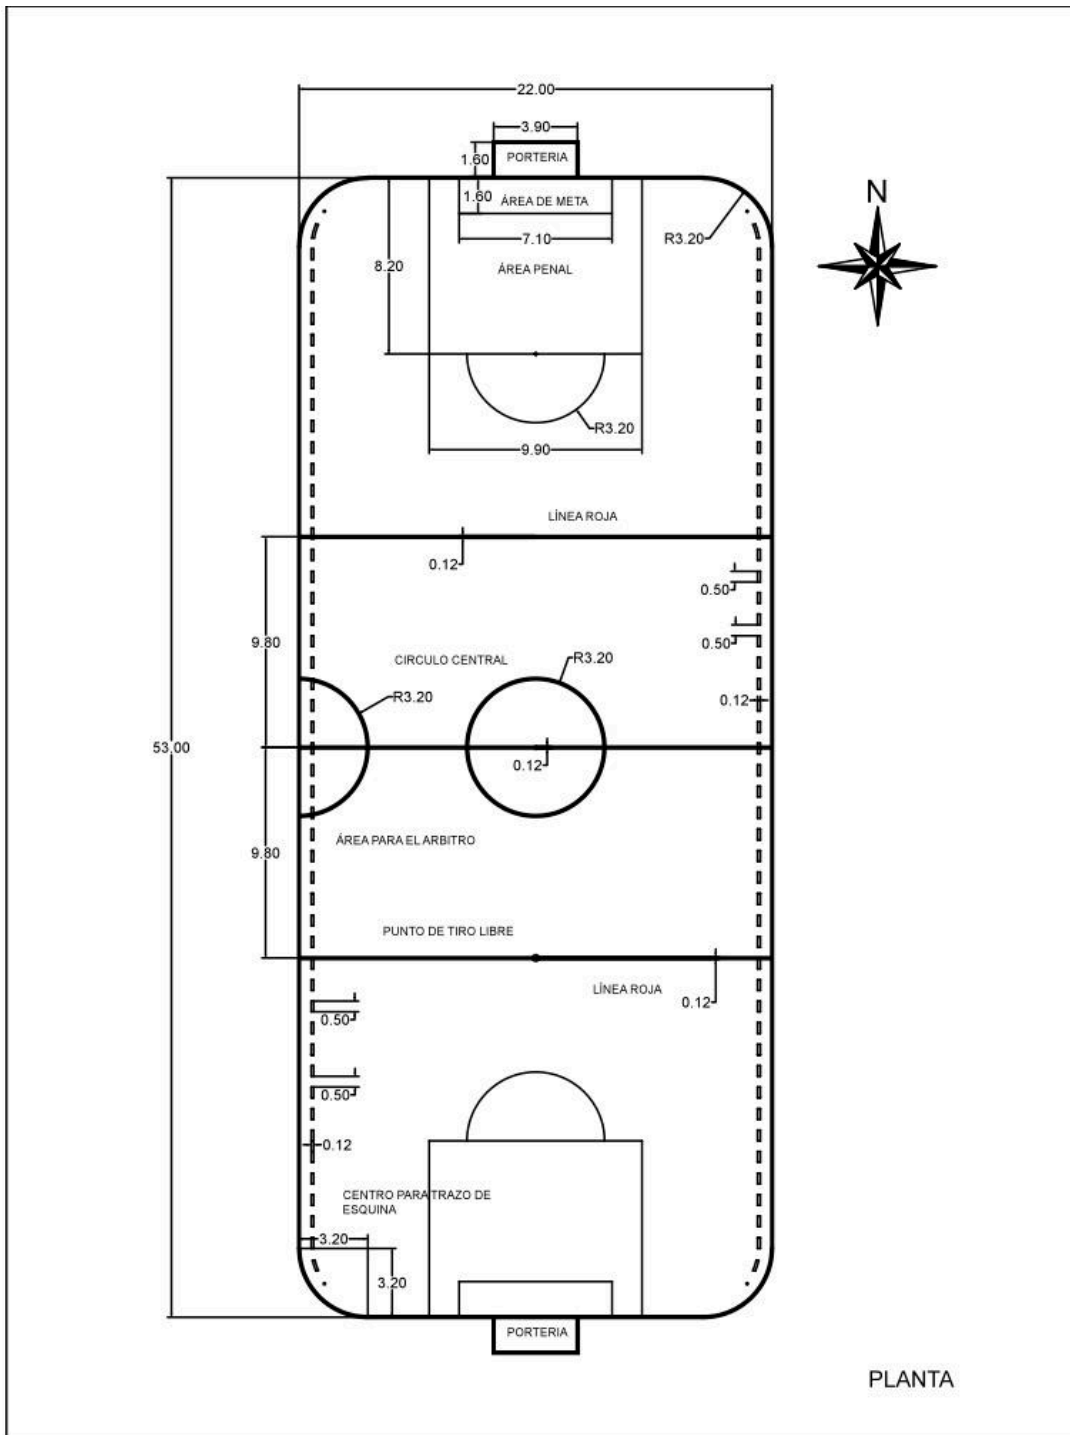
Planta de una cancha de fútbol rápido. Fuente: Elaboración propia
